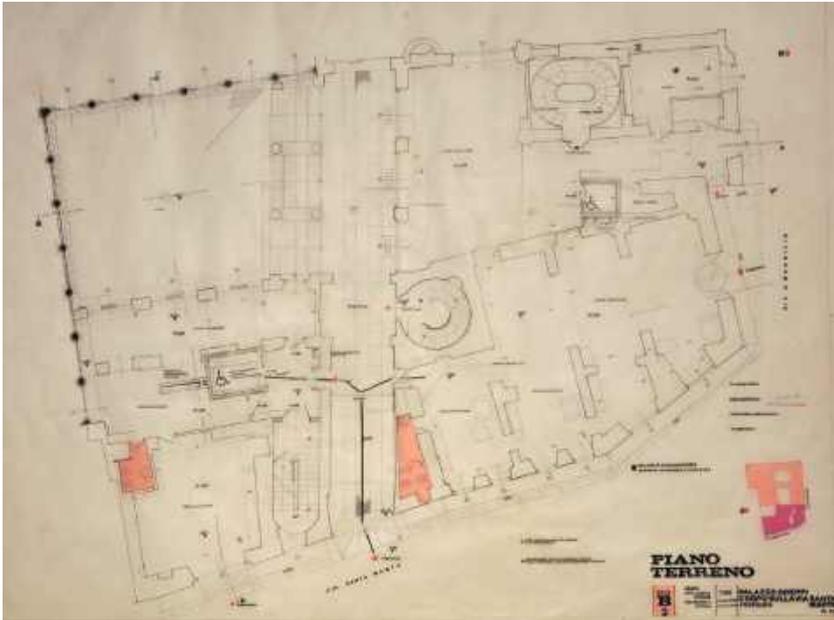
Corpo su via Santa Marta, pianta piano terreno, progetto di restauro e ristrutturazione; tavola su lucido
